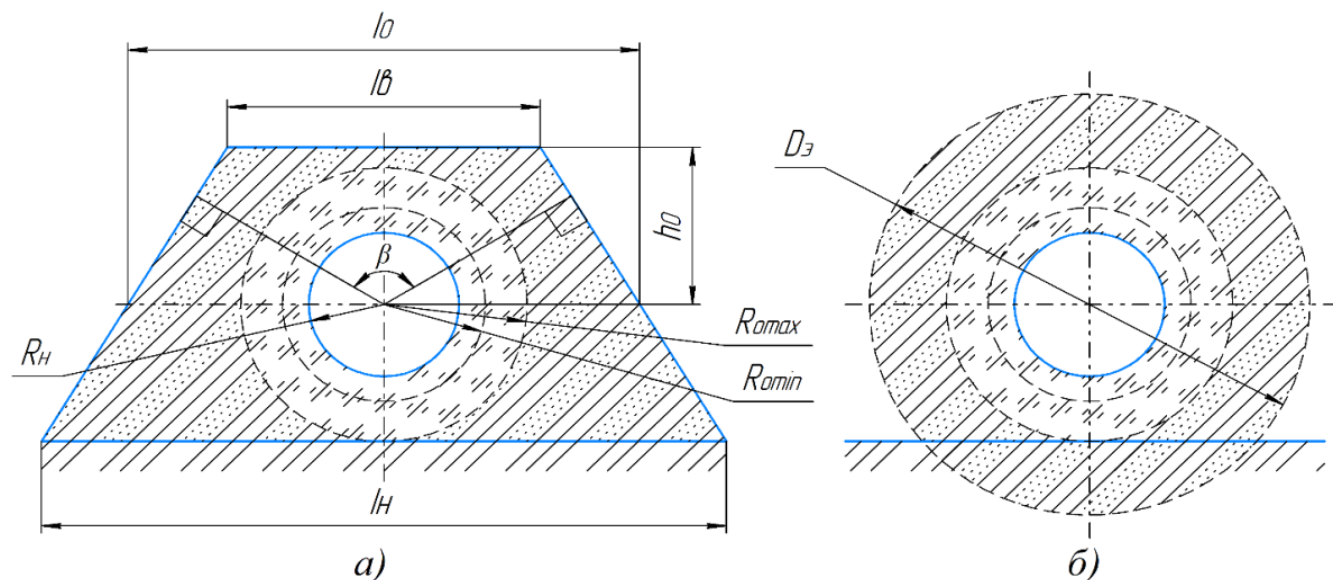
а) Схема наземной прокладки в насыпи; б) эквивалентная расчетная схема
